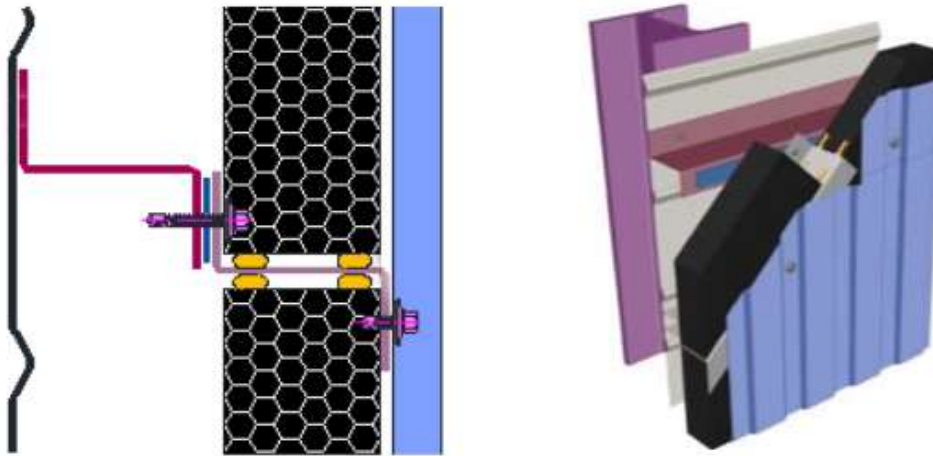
Schéma de principe de disposition de traitement pour recouvrement transversal de la peau d'étanchéité (fixation du Z de recouvrement)
